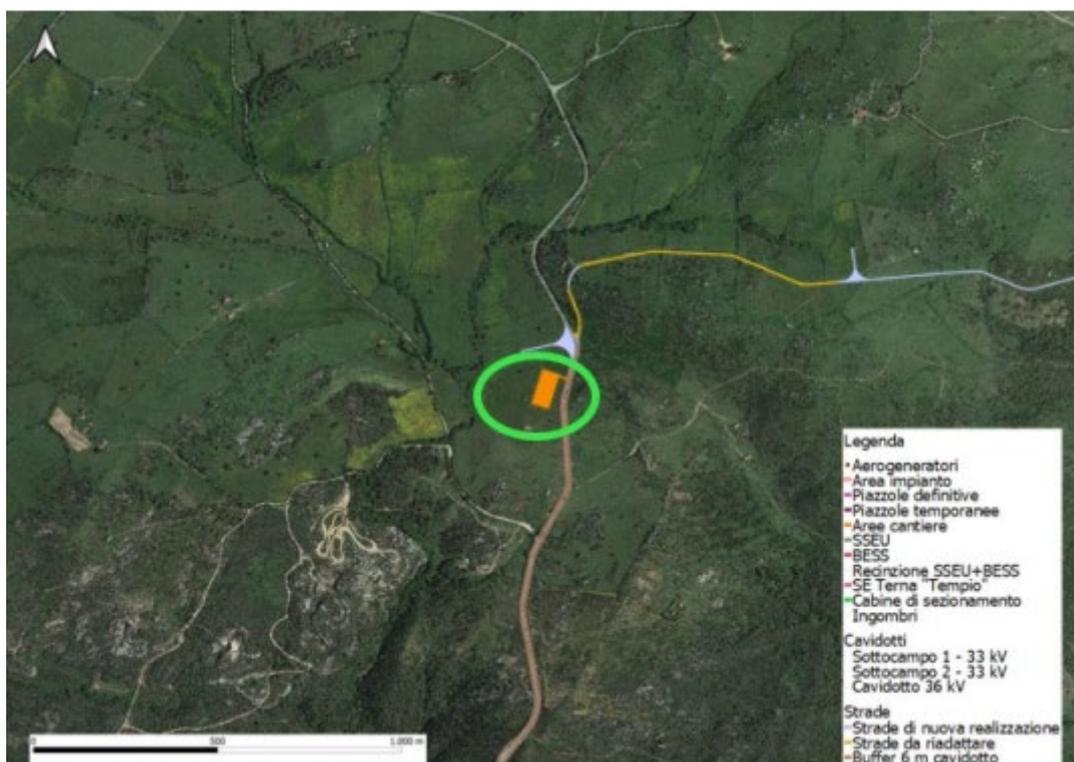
Area di Cantiere 3 - superficie 5.114 mq
